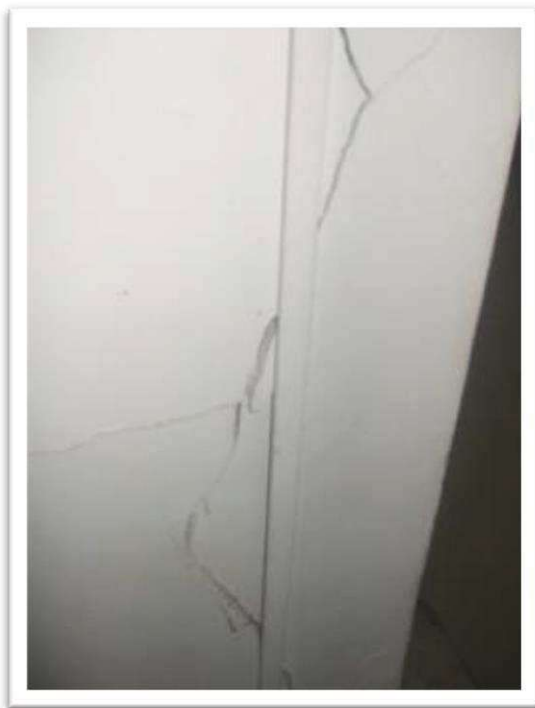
Outro trecho da parede na região da escada caracol onde parte do azulejo caiu.
